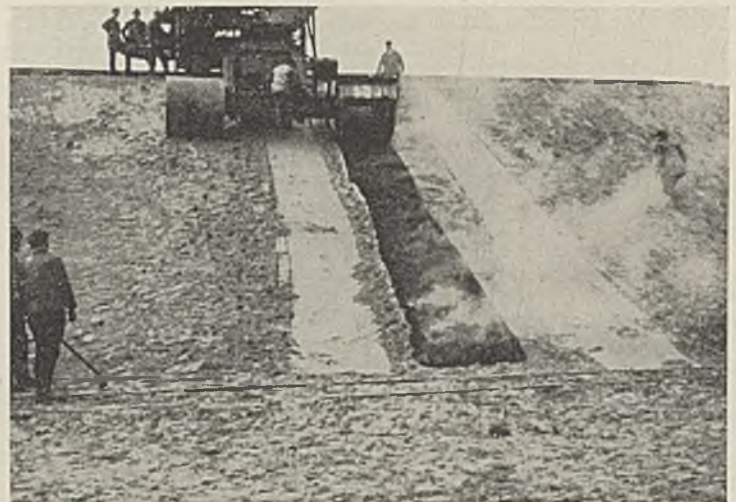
Einbau einer Dichtungsbahn im geschütteten Sanddamm ohne jede Vorbereitung des Untergrundes.
